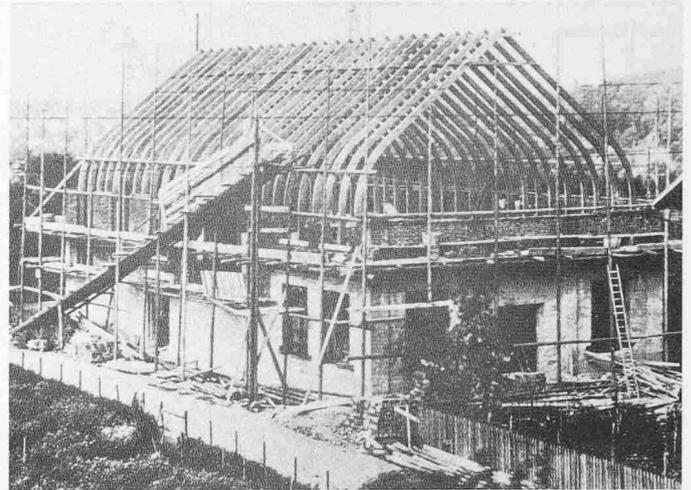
Dachkonstruktion des Apparatehauses der Konservenfabrik Lenzburg
